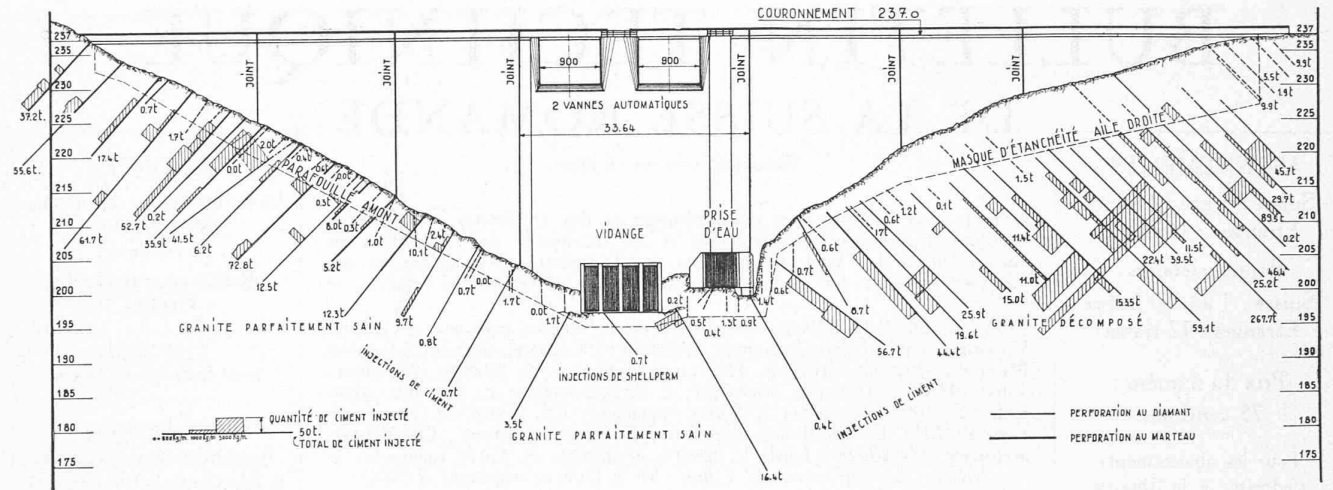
, 3 et 4. — Elévation amont, plan et coupe longitudinale du barrage d'Ermal. Echelle 1 : 1000.
